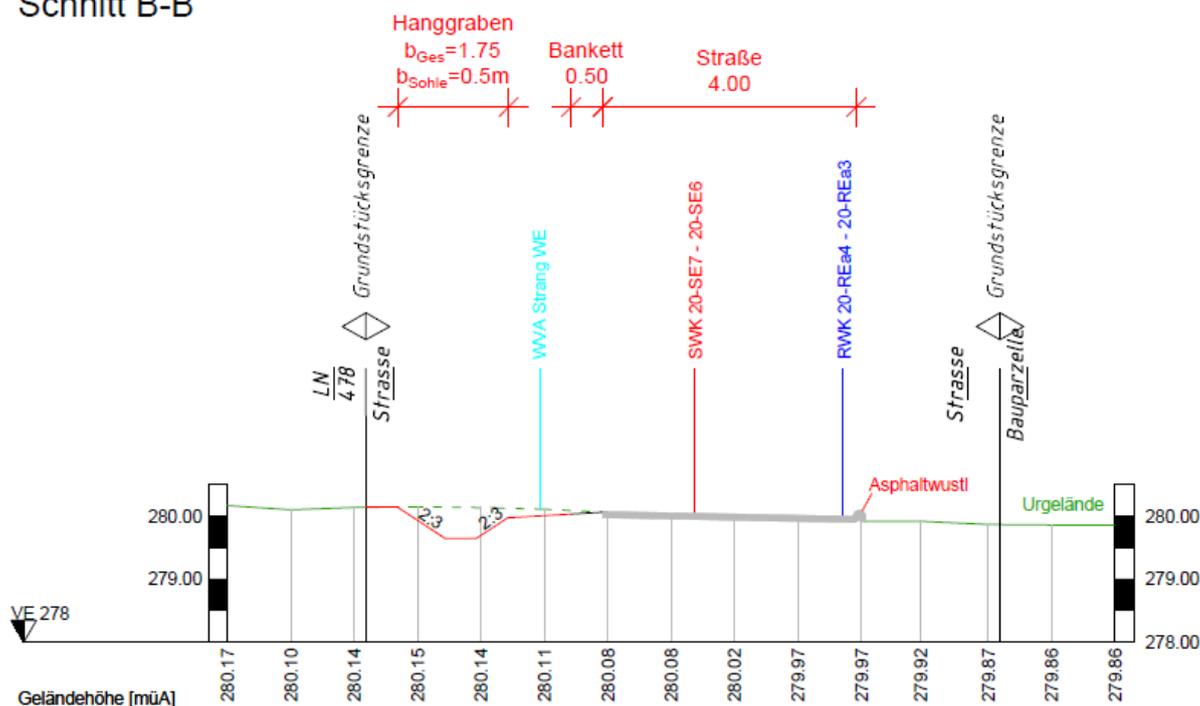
Regelprofil Aufschließungsstraße mit Entwässerungsgraben
